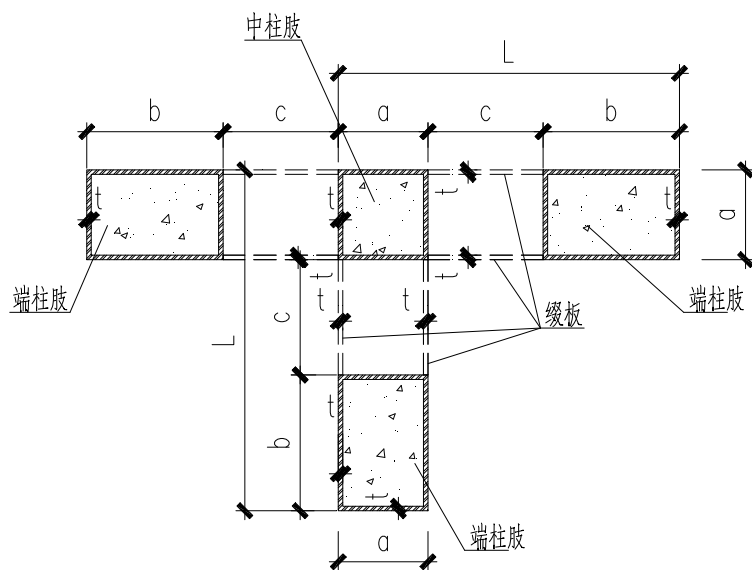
缀板式钢管混凝土组合柱缀板布置示意图
